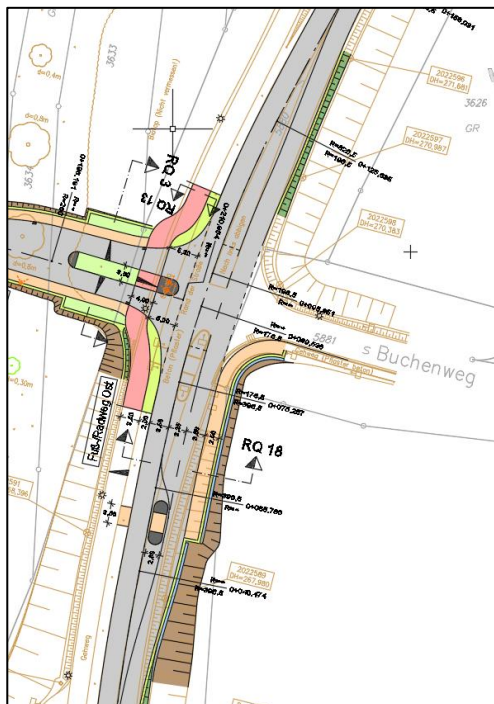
Auszug Lageplan Straßenbau – Entwurfsplanung, Rapp Regioplan GmbH, 17.01.2020
